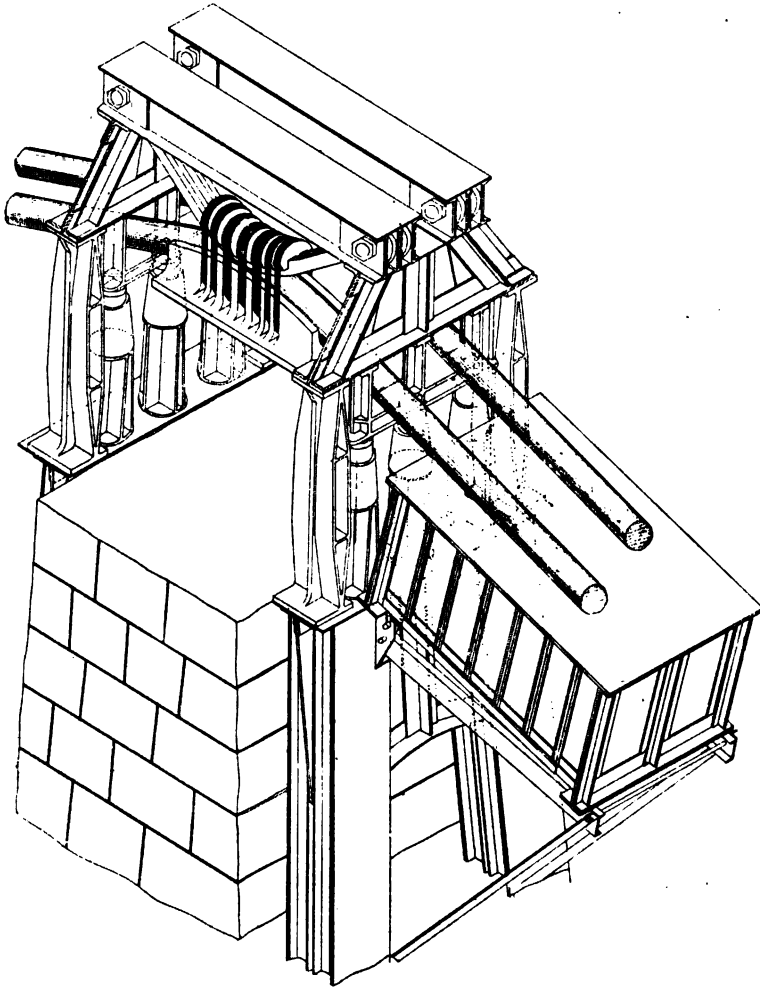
Appareil pour le Changement des Sommiers du Pont suspendu de Niagara.
